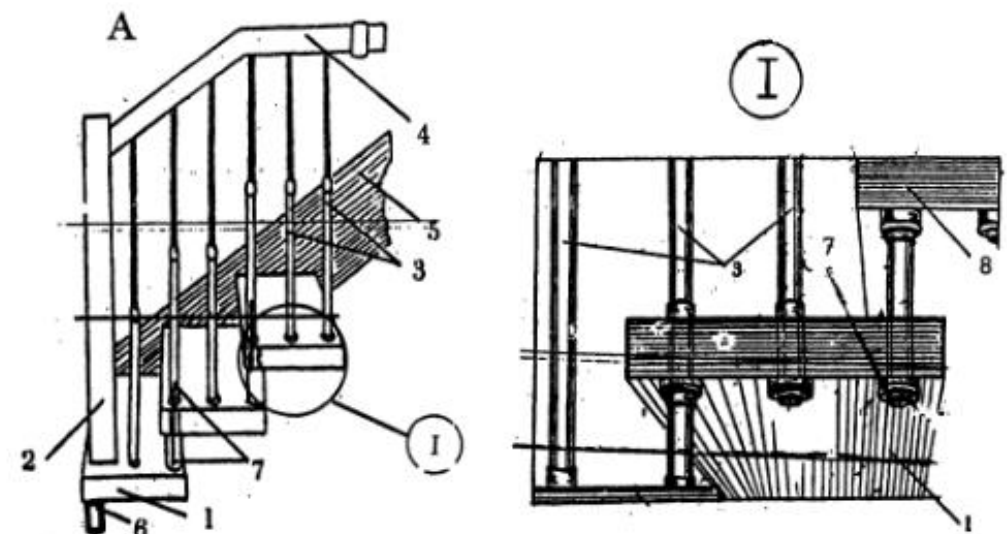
Вариант деревянной лестницы с подвеской ступени к перилам: А - общий вид; 1 - нижняя ступень; 2 - балясина; 3 - стойка перил; 4 - перила; 5 - тетива; 6 - анкерный болт; 7 - резьбовое соединение; 8 - верхняя ступень
